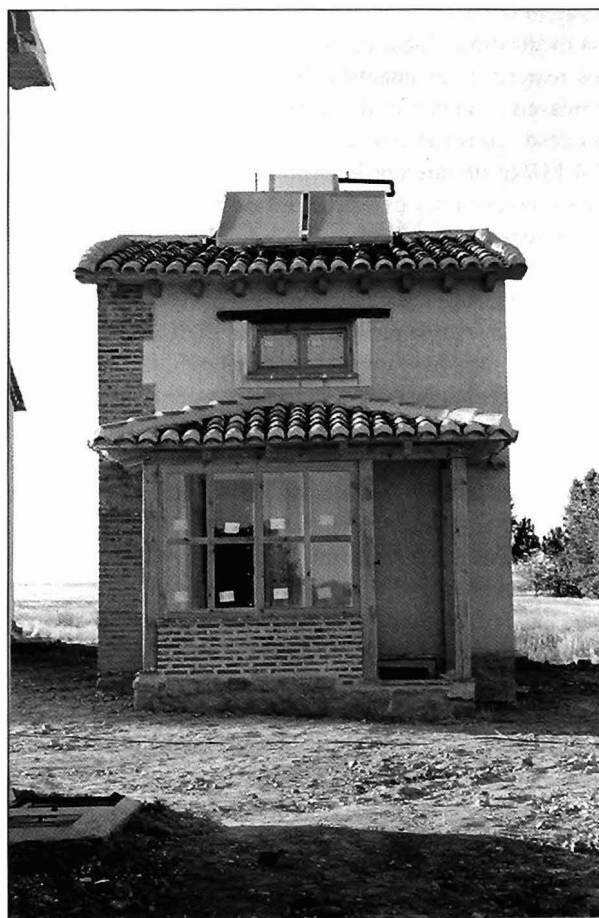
Fachada Sur, con galería boca de la gloria, y paneles de energía solar térmica.
